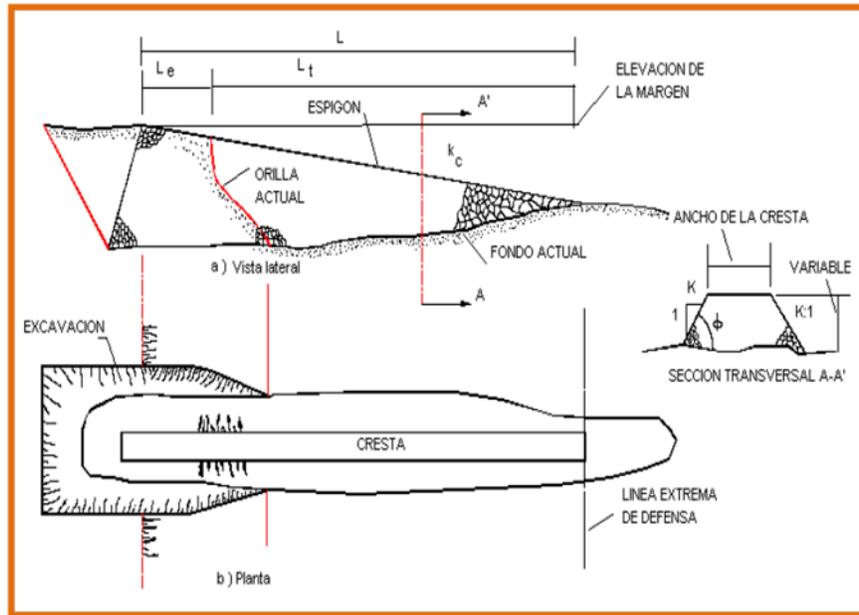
, Espigón de mampostería empotrado al margen del cauce.
